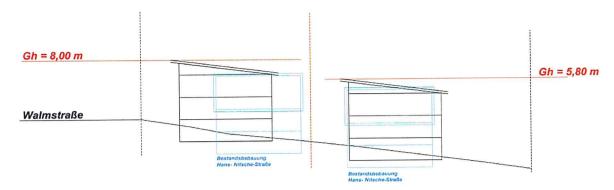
Schnittbeispiel Plangebiet M 10 C (Nachbarbebauung Hans-Nitsche-Straße Nr. 2-6)
